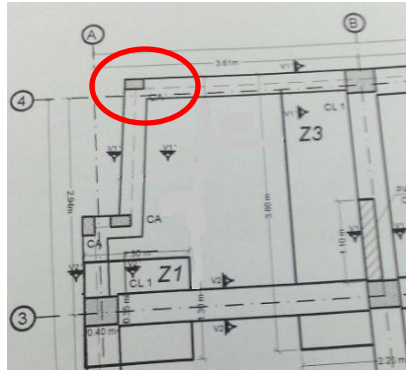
Hace falta realizar zapata de cimentación.
